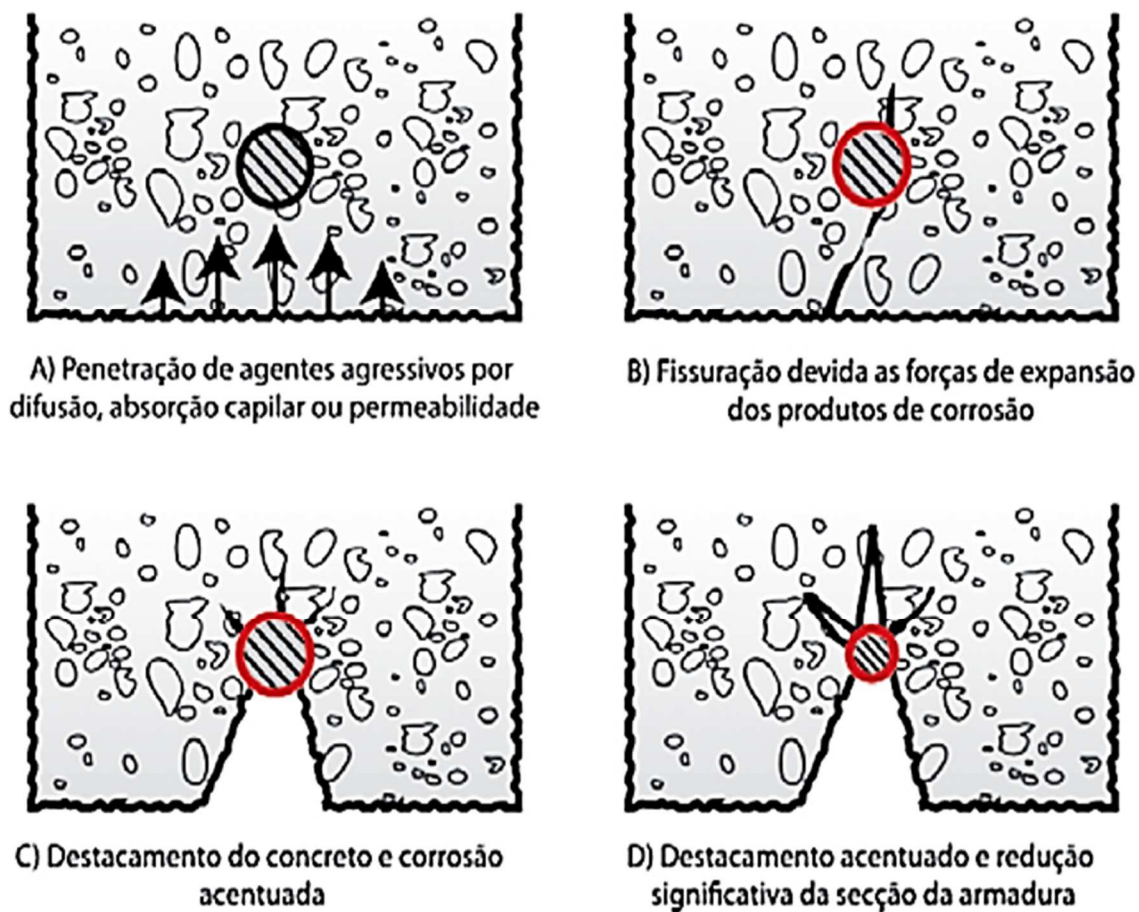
Evolução esquemática da deterioração de estruturas de concreto devido a corrosão das armaduras.
